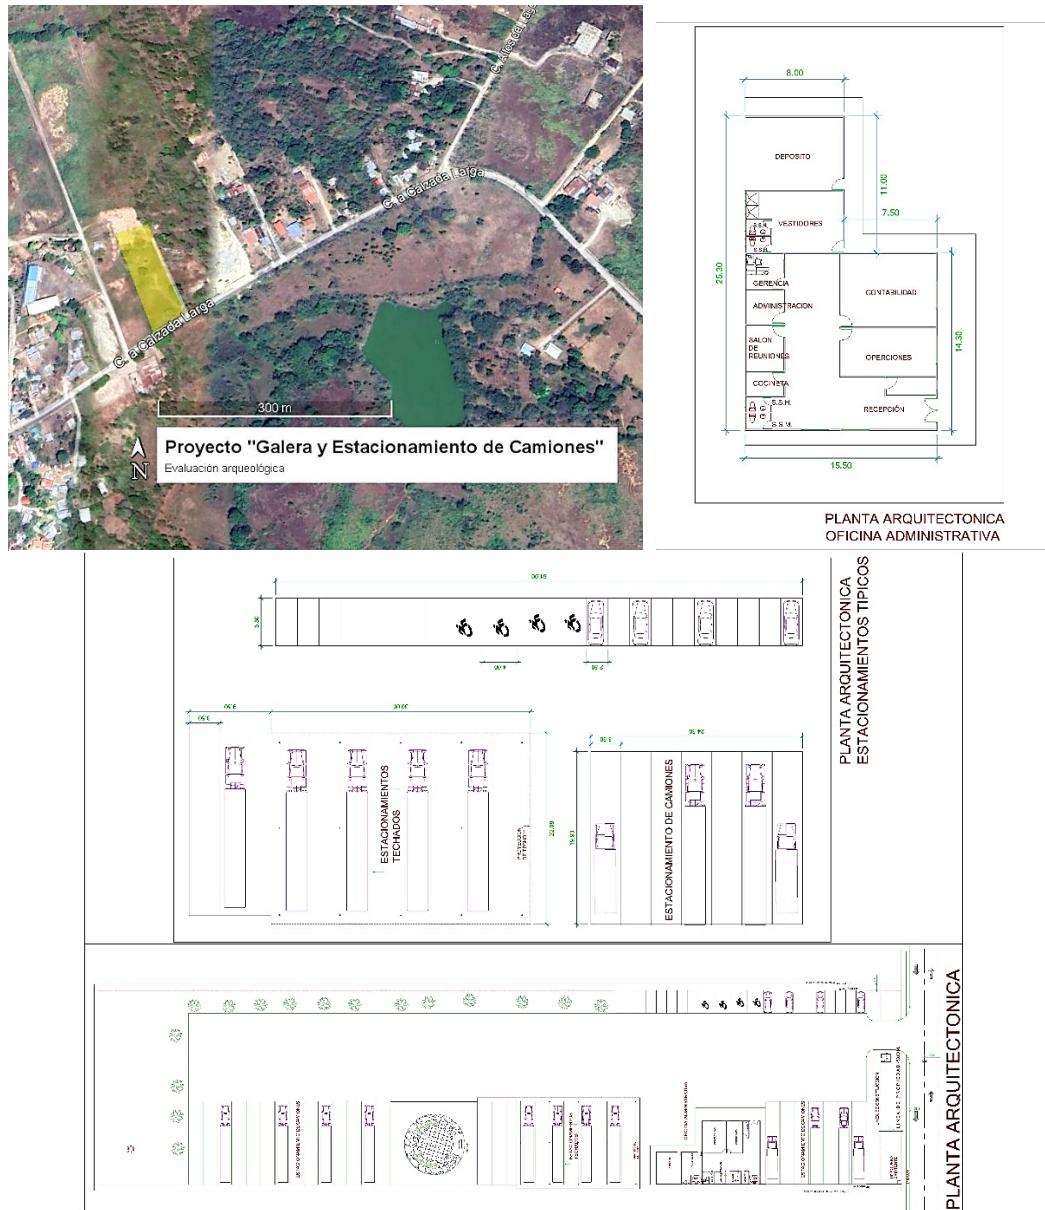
Detalles de ubicación del proyecto propuesto en Calzada Larga, Caimitillo.
